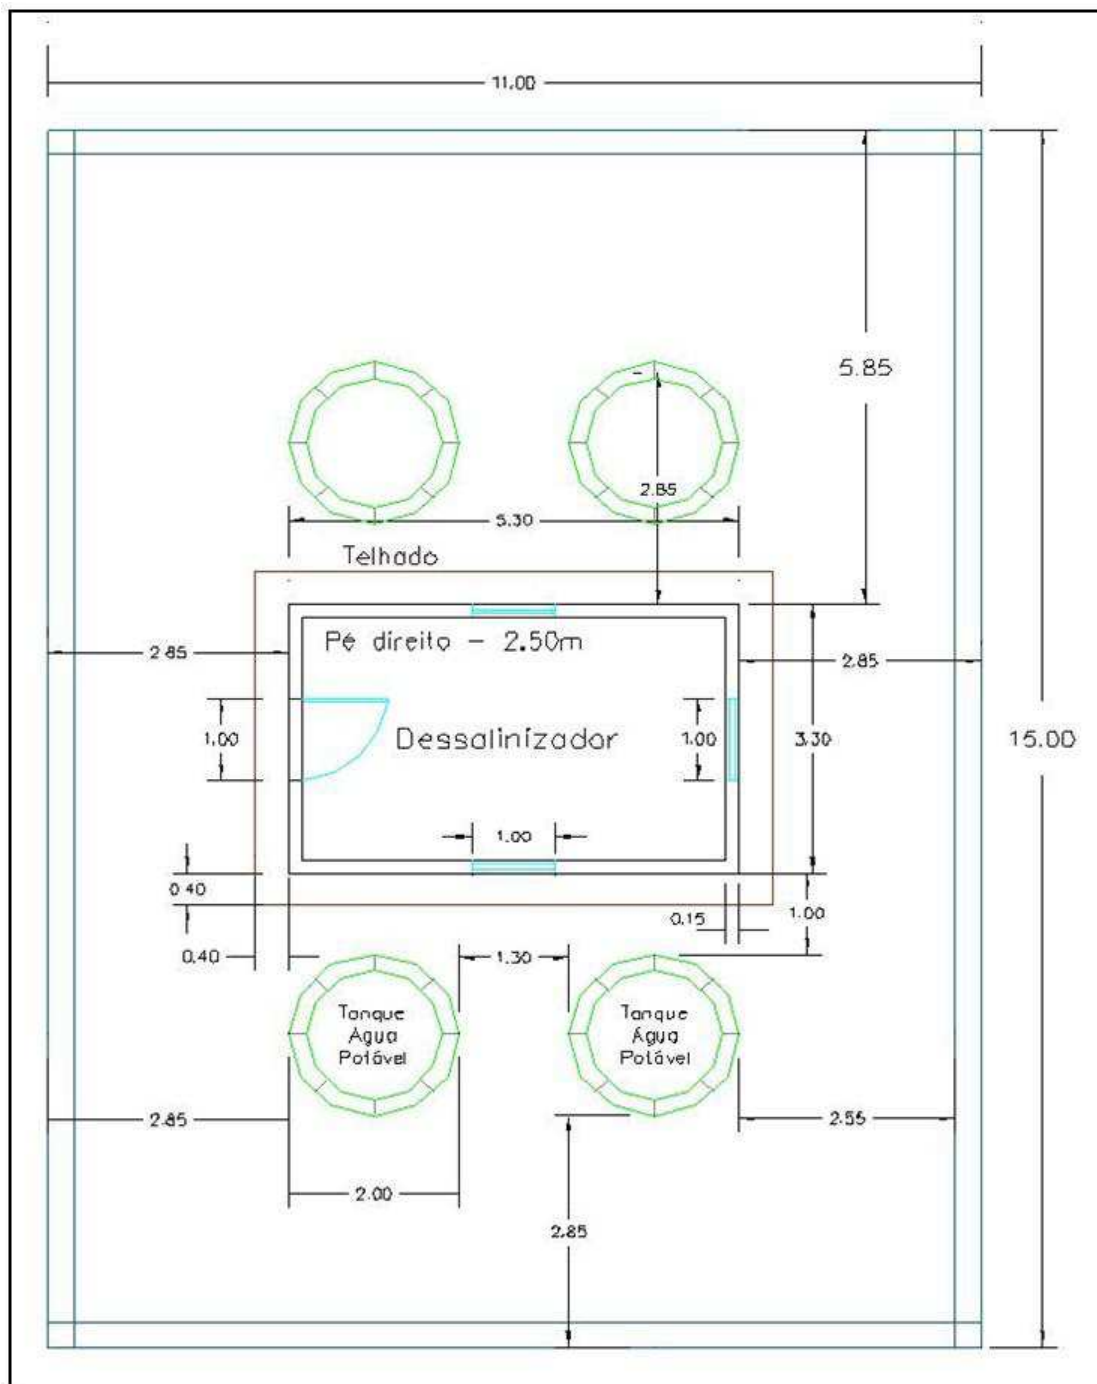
Planta baixa do abrigo e da plataforma do sistema de dessalinização
